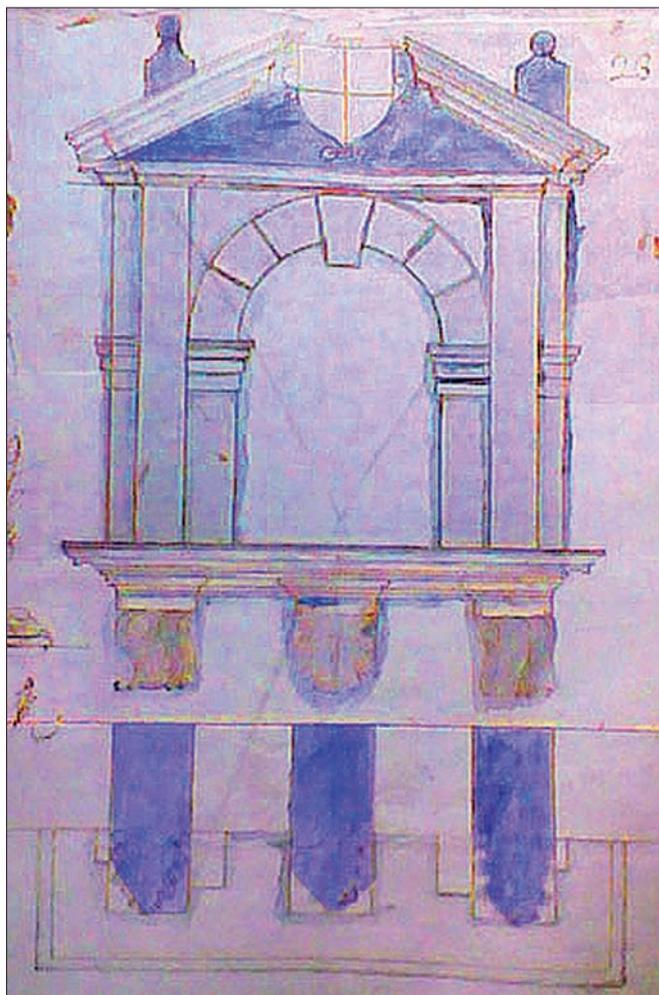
Altar destinado a cobijar una imagen del Santo Ángel de la Guarda en la torre del Ayuntamiento. Proyecto de Juan de Estrada ejecutado entre 1671 y 1673 (A.H.P.A.)
